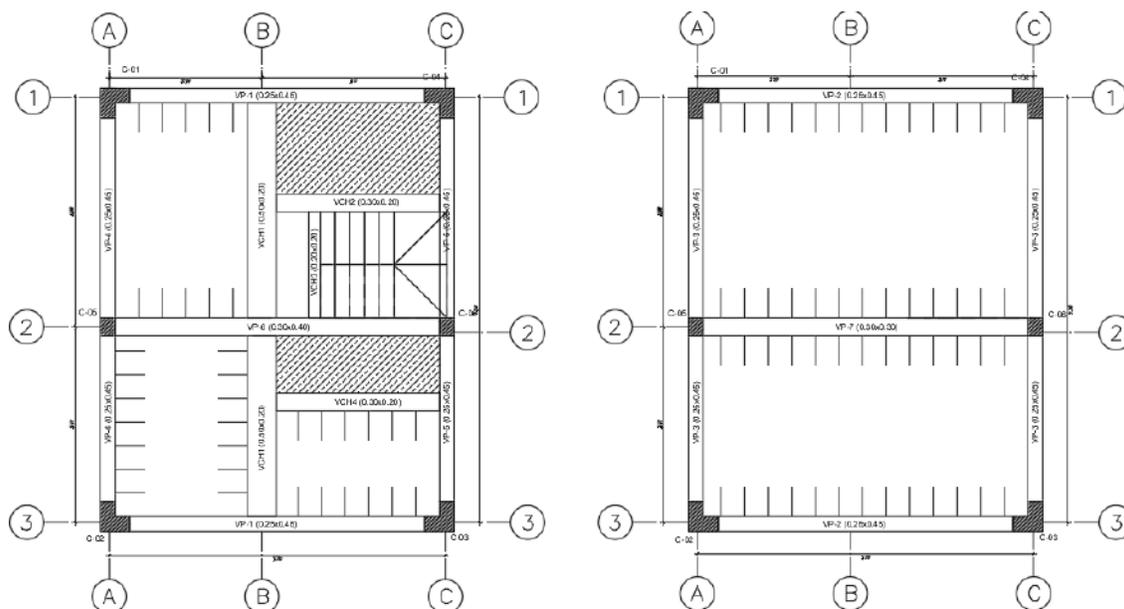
Estructuración de la vivienda en base al plano arquitectónico. Fuente: Propia.
